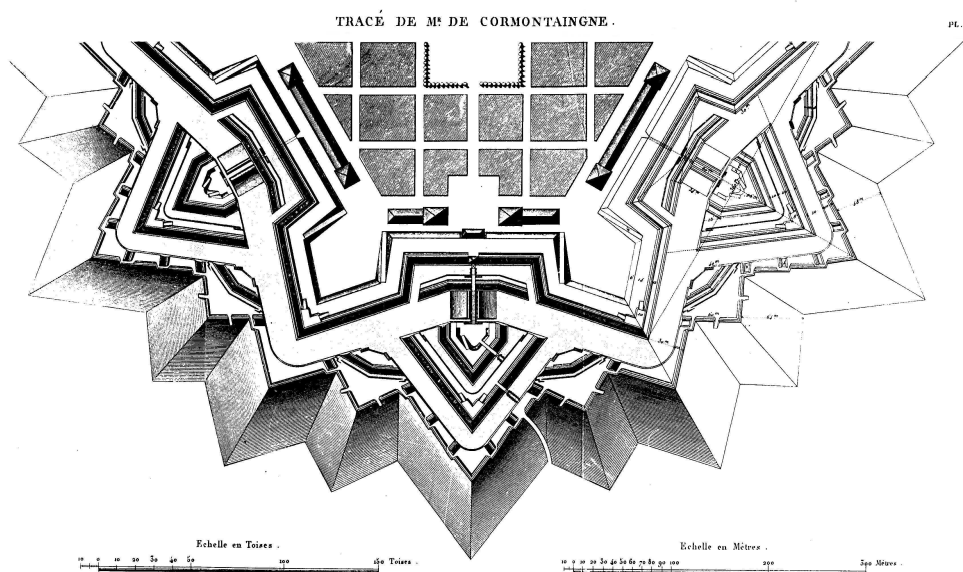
Planta del trazado tipo de *Cormontaigne*.
